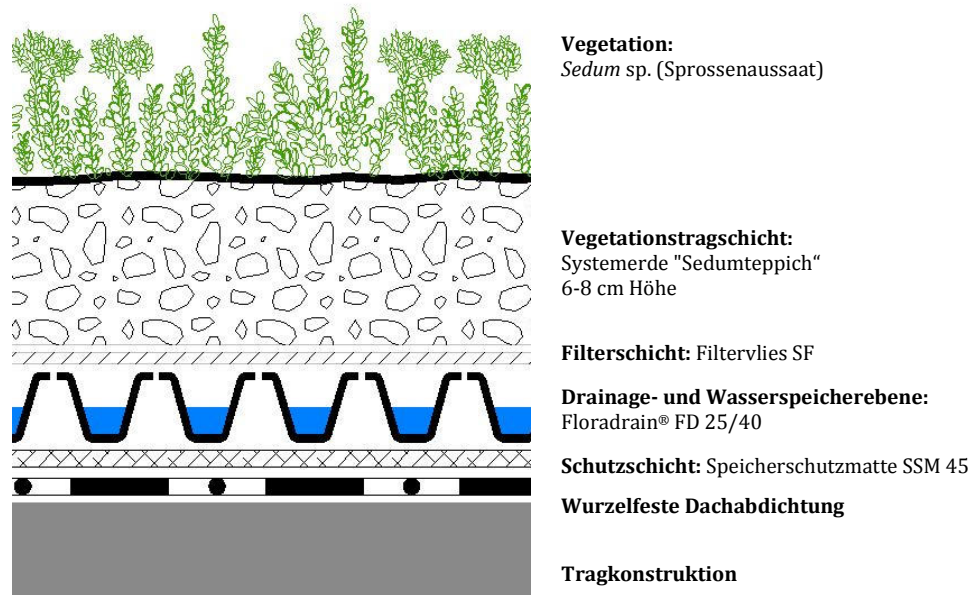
Standardsystemaufbau extensive Dachbegrünung mit *Sedum*-Vegetation
